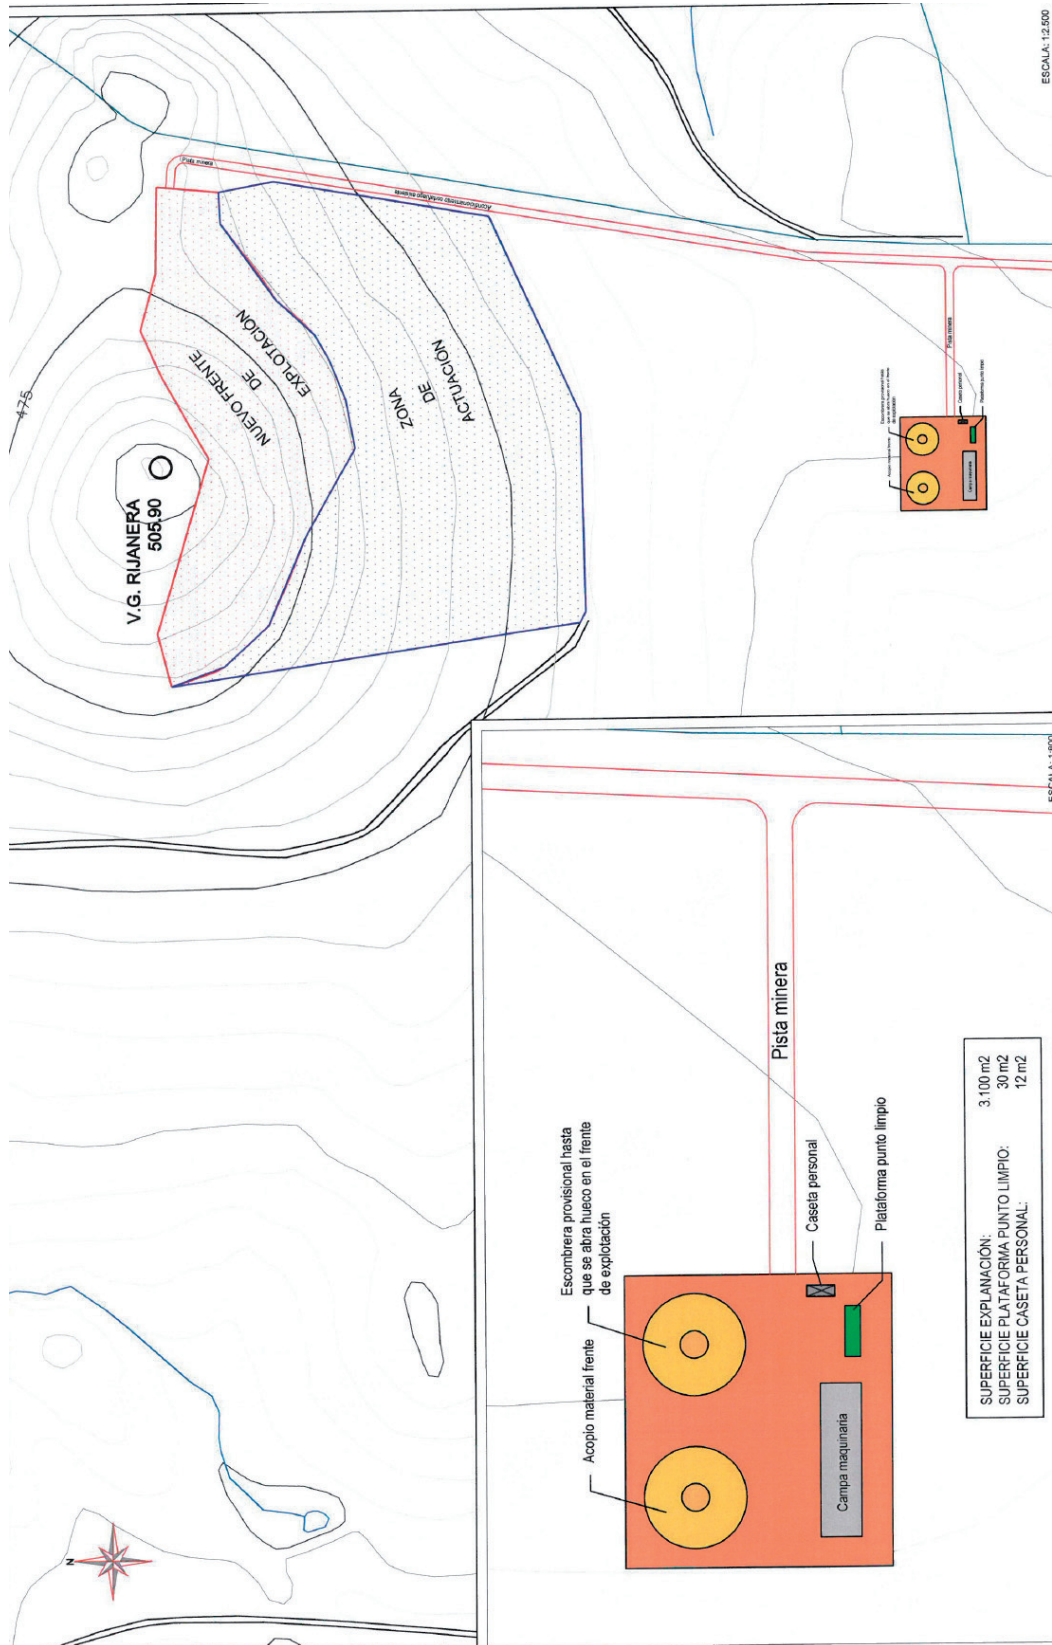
Plano en planta de la instalación industrial, incluyendo la explanación provisional.
